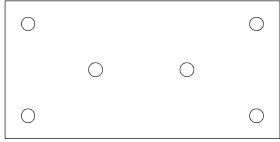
Plans de chevillage - panneaux de dimensions $1000 \times 500 \text{ mm}$
